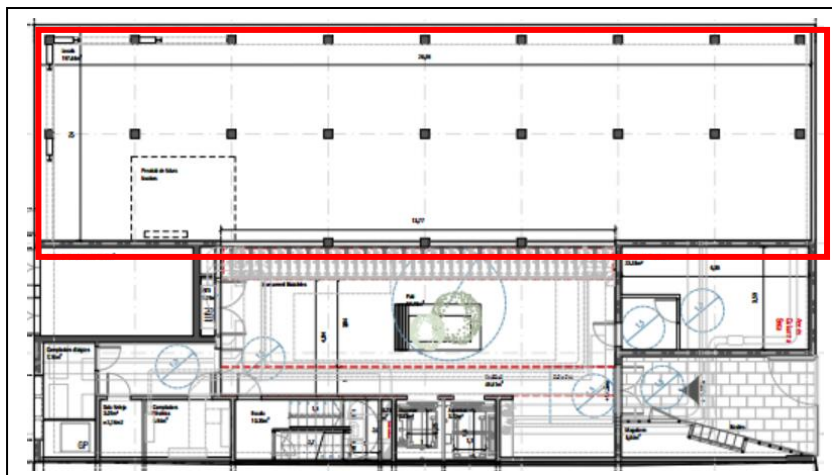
Ubicación en planta baja del recinto emisor del ensayo ACU-24-119841 (27).
